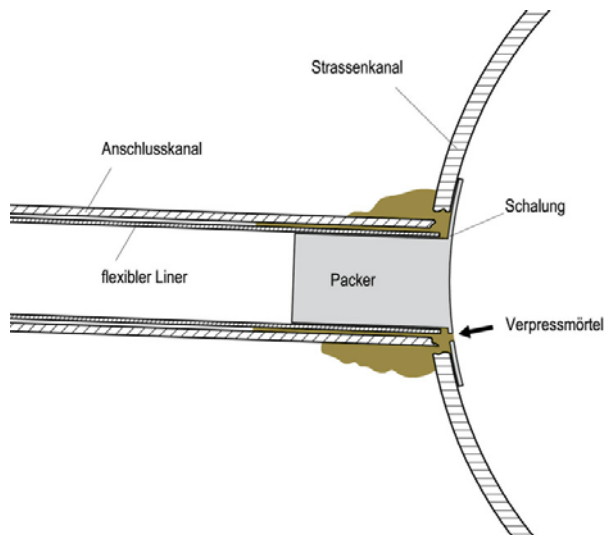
Sanierter Anschlussstutzen mit eingebundenem Flexorenrohr
